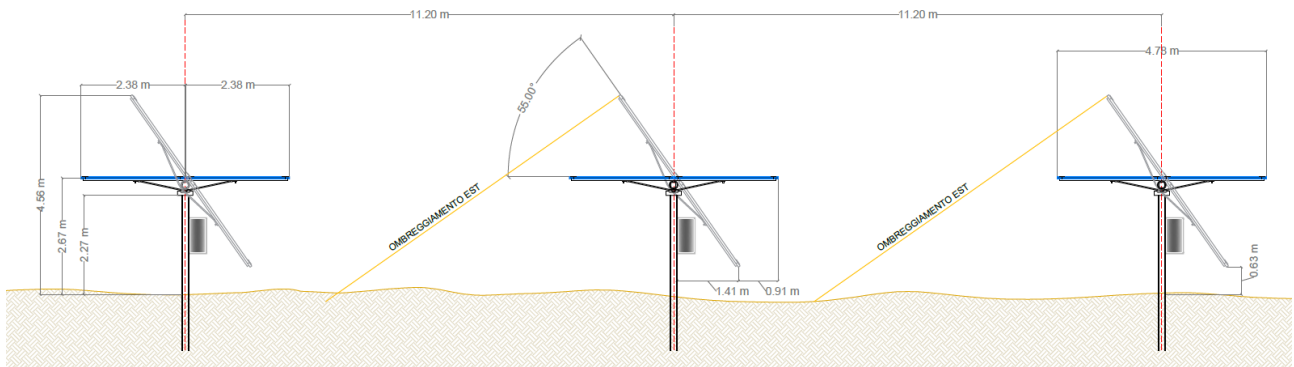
Vista frontale con rotazione di 55° est e distanza longitudinale tra le strutture
